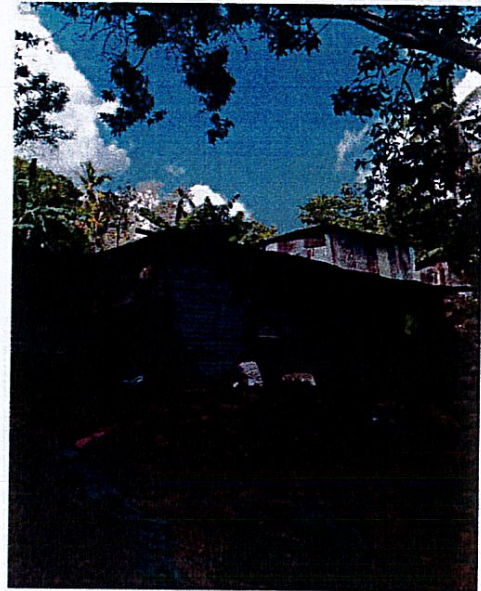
emplacement logement dangereux, risques de chute et blessures.
